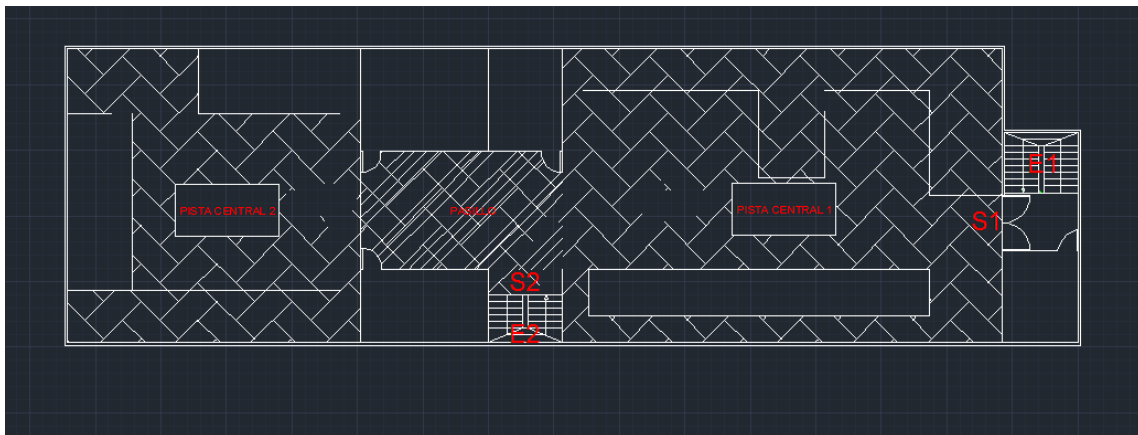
“Plano de la planta del primer piso de la discoteca 2 en formato DXF.”
